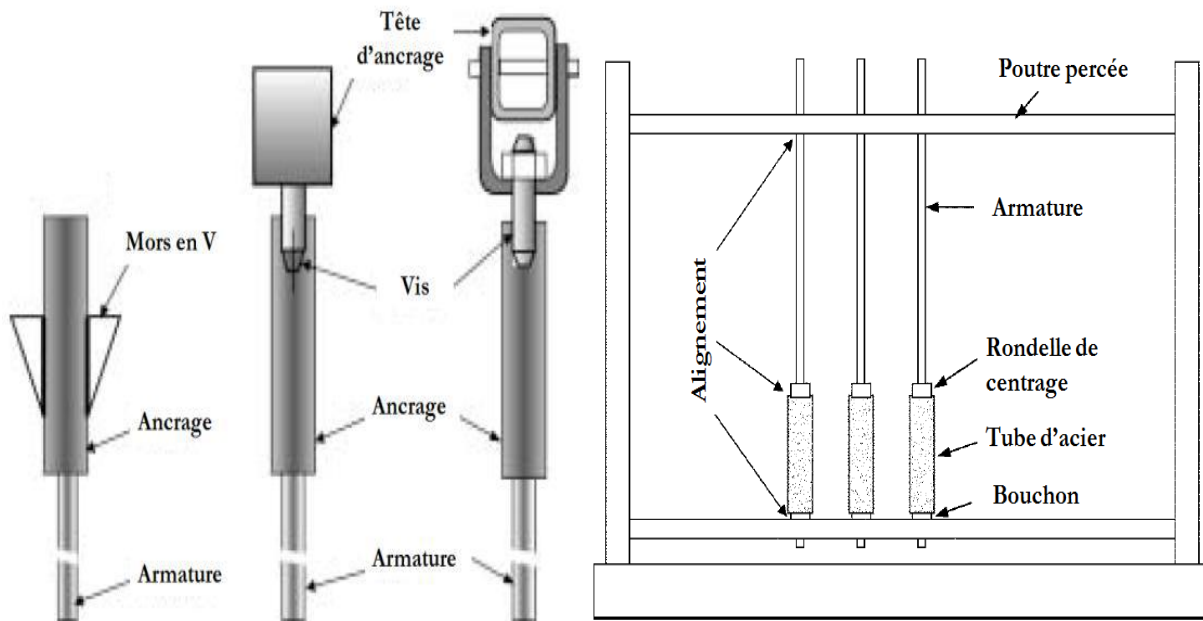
Propositions d’ancrages pour essais de tractions sur armatures PRF
